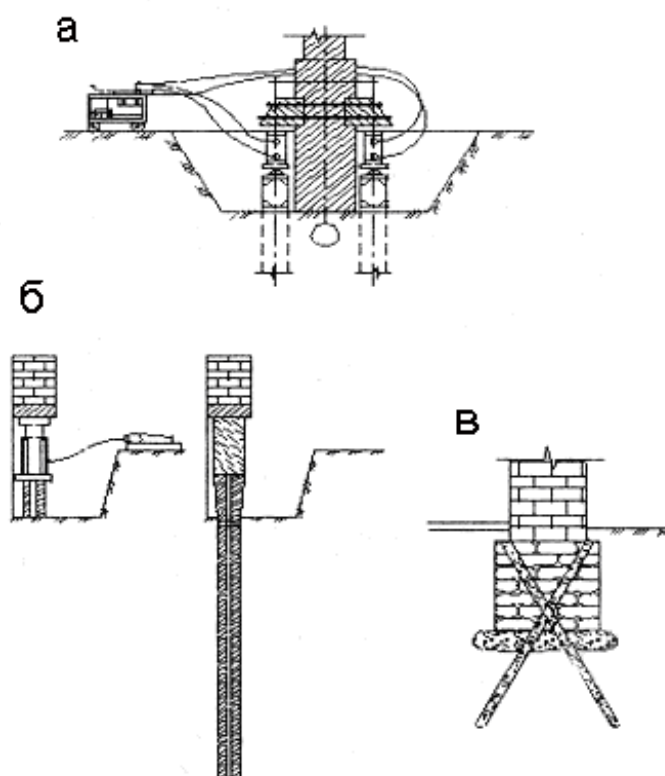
Усиление фундаментов с использованием свай:
